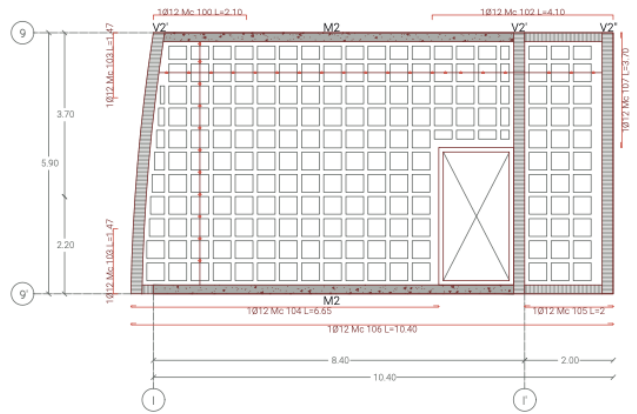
Cadena de cimentación y vigas (Elaboración propia)
